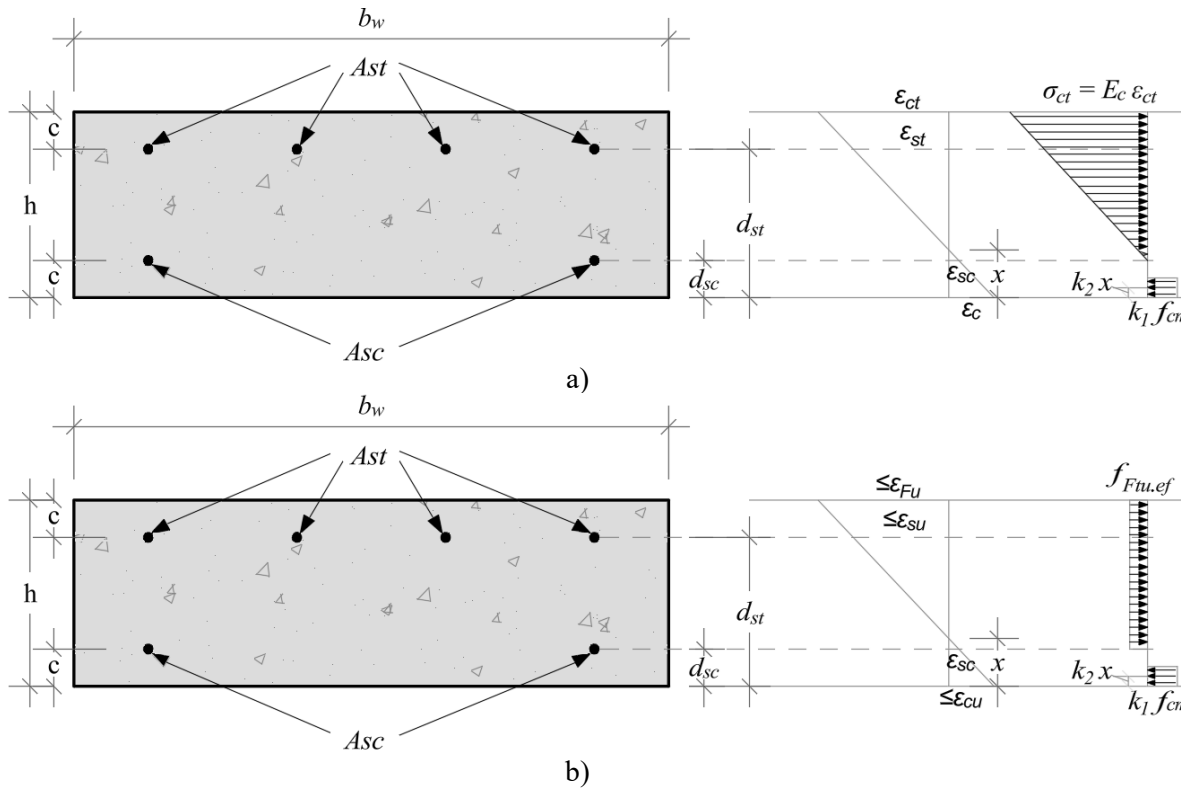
Diagramas de distribuição de extensões e tensões na seção de momento negativo em: a) betão não fissurado; b) SFRC fissurado.
